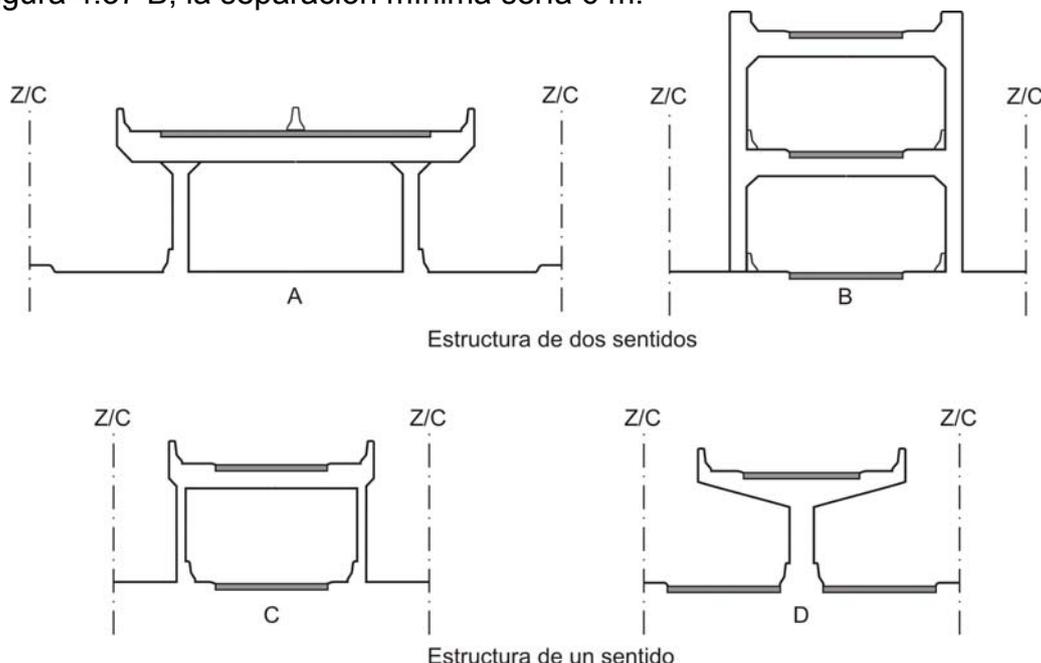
Secciones transversales típicas; autopistas urbanas en estructuras sin ramas
